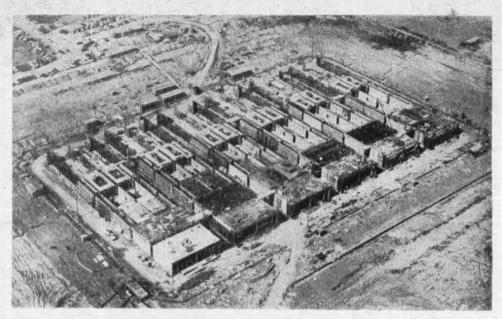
Construcción de los elementos de túnel en el dique seco.
